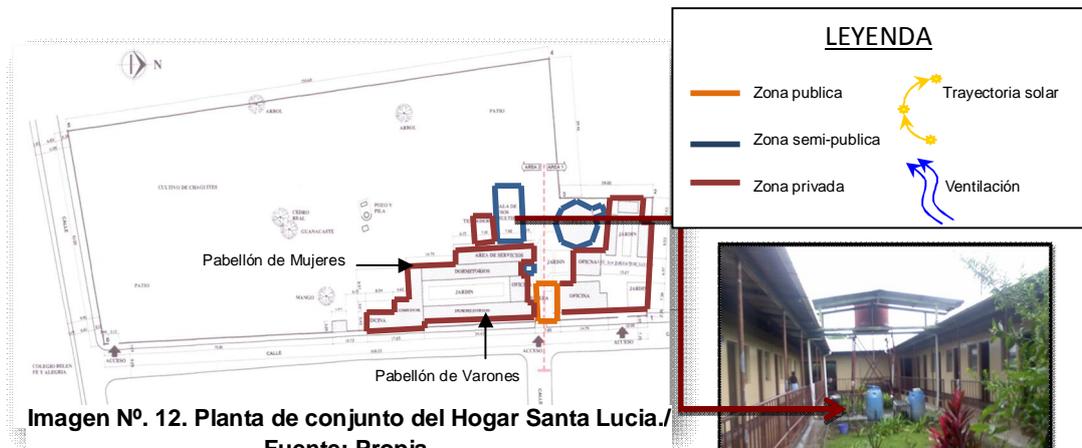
Planta de conjunto del Hogar Santa Lucia./ Fuente: Propia.
